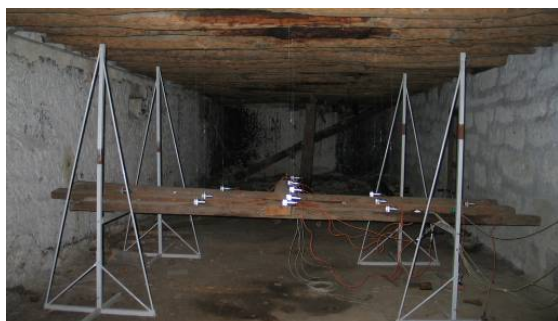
Estrutura montada sob o pavimento para colocação dos LVDT.
